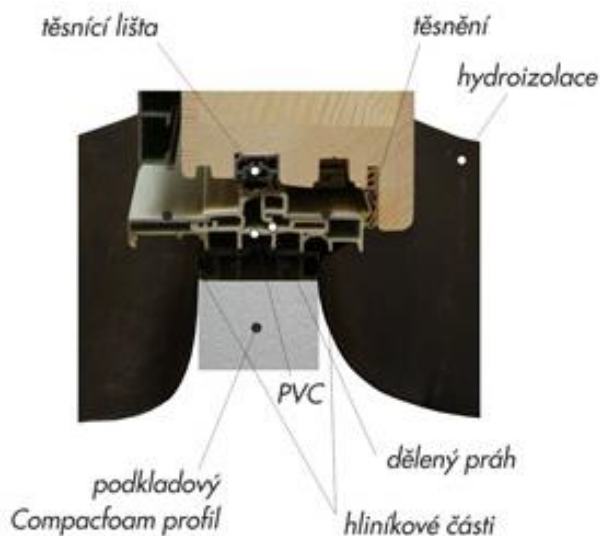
Nejpoužívanější druhy prahové konstrukce
